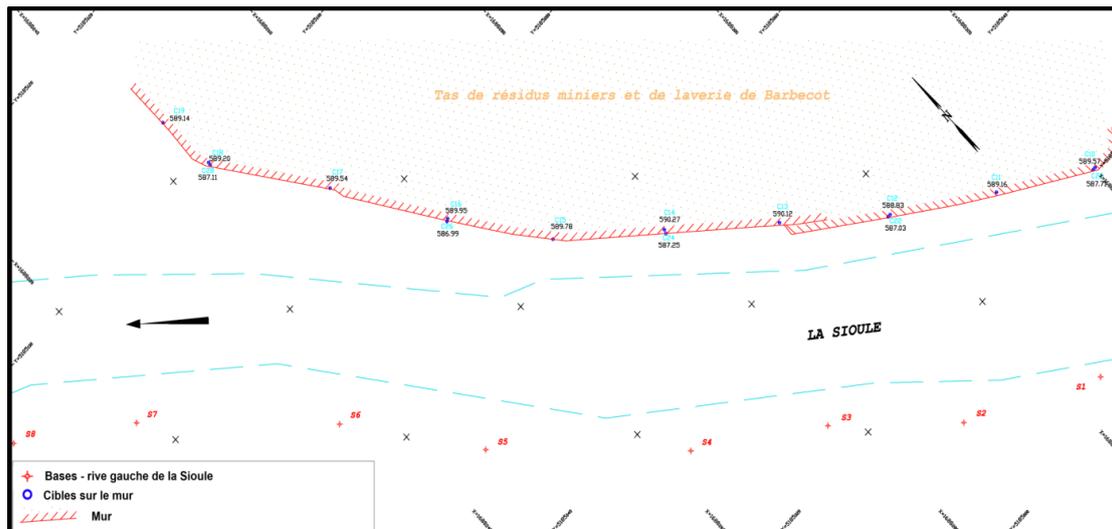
Vue en plan des bases et des cibles – Mur de Barbécot.
